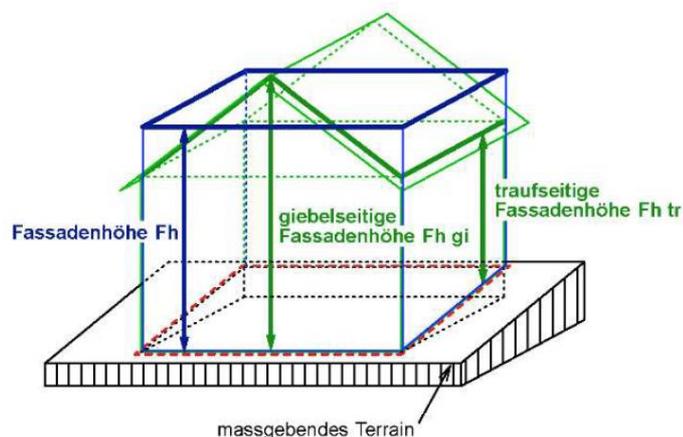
Skizze zur giebelseitigen Fassadenhöhe (FH gi), traufseitigen Fassadenhöhe (FH tr) und Fassadenhöhe (Fh)
